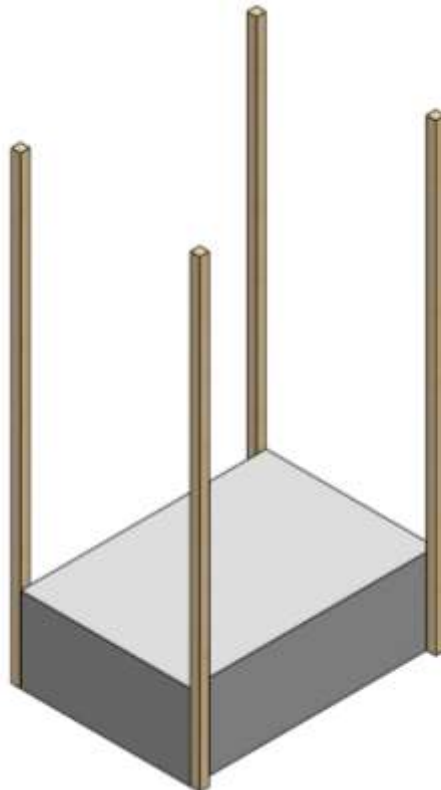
Vigas atornilladas a la estructura (Elaboración propia).
